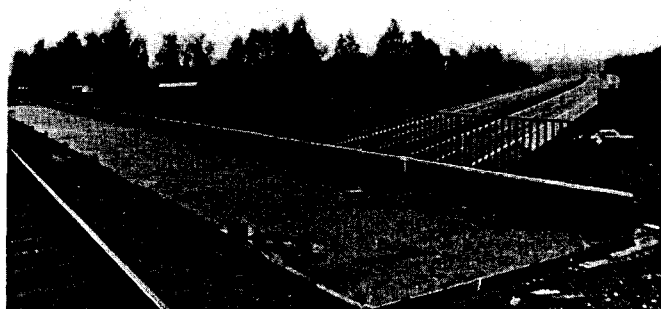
Gesamtansicht einer mit SYLOMER-Matten belegten Stahlbrücke der Deutschen Bundesbahn vor dem Einbau des Schotters
